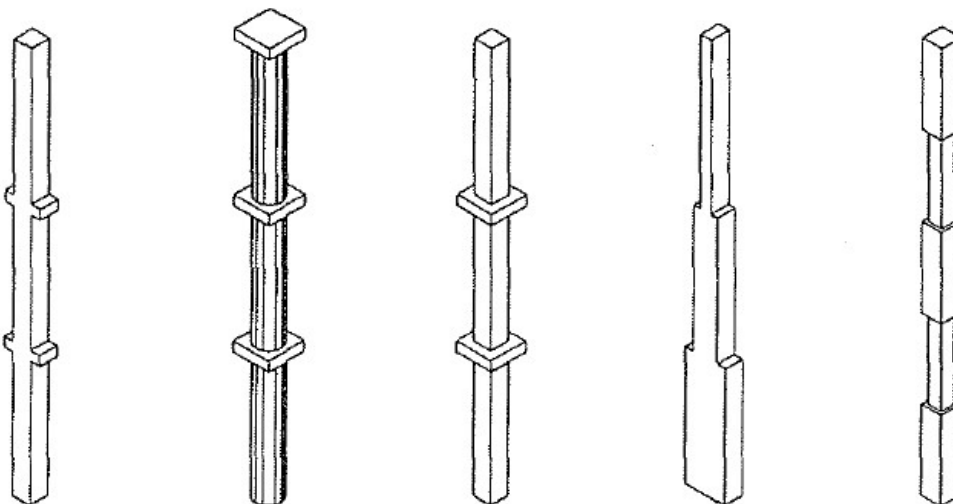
Formas dos pilares ao longo do seu comprimento (Els Debs, 2000)
